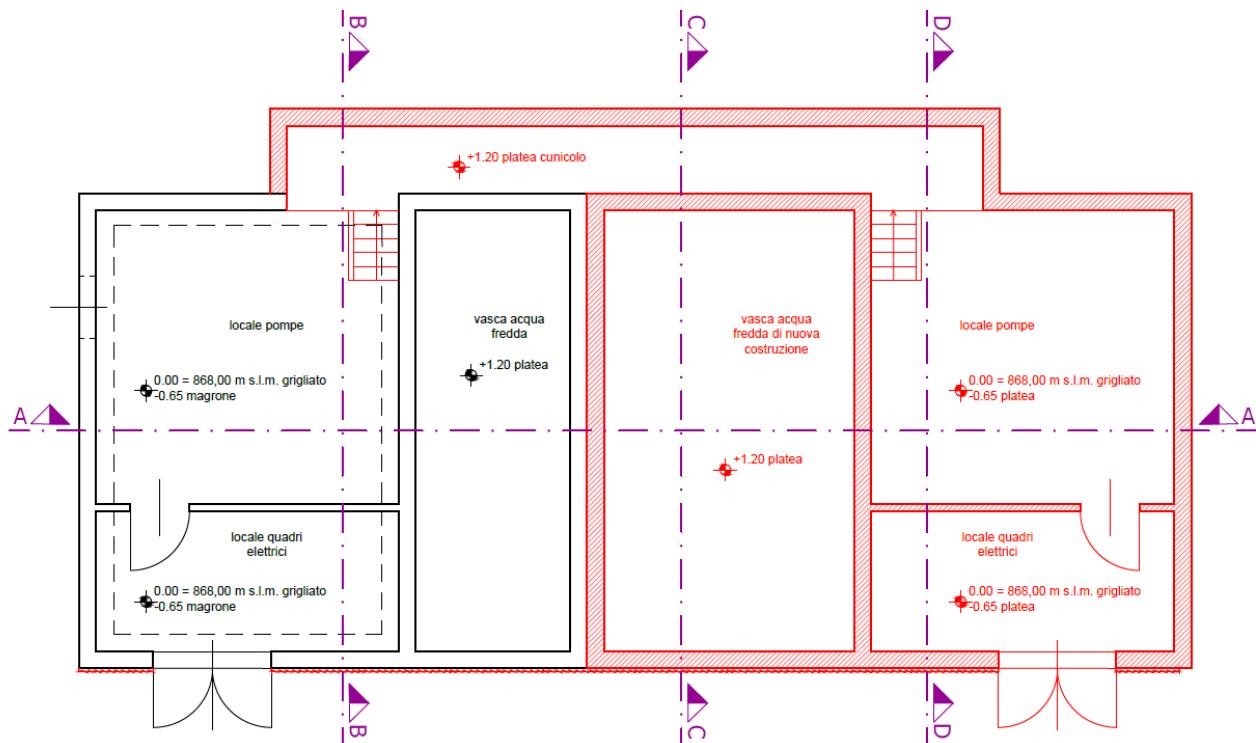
Estratto pianta raffronto locale pompe - sala a vista
